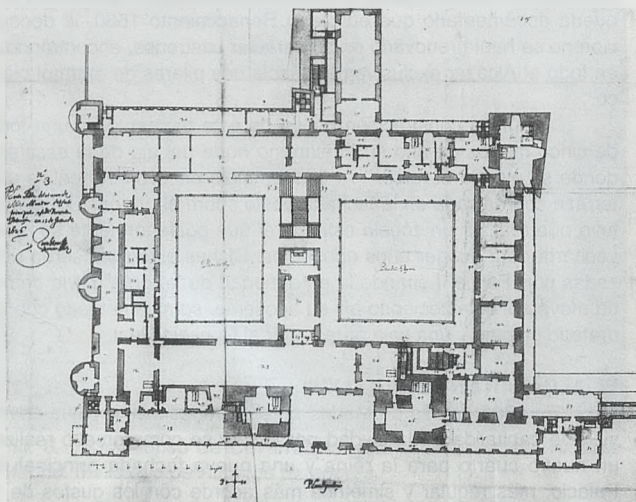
1626 Juan Gómez de Mora. Planta principal del Alcázar. Biblioteca Apostólica Vaticana
